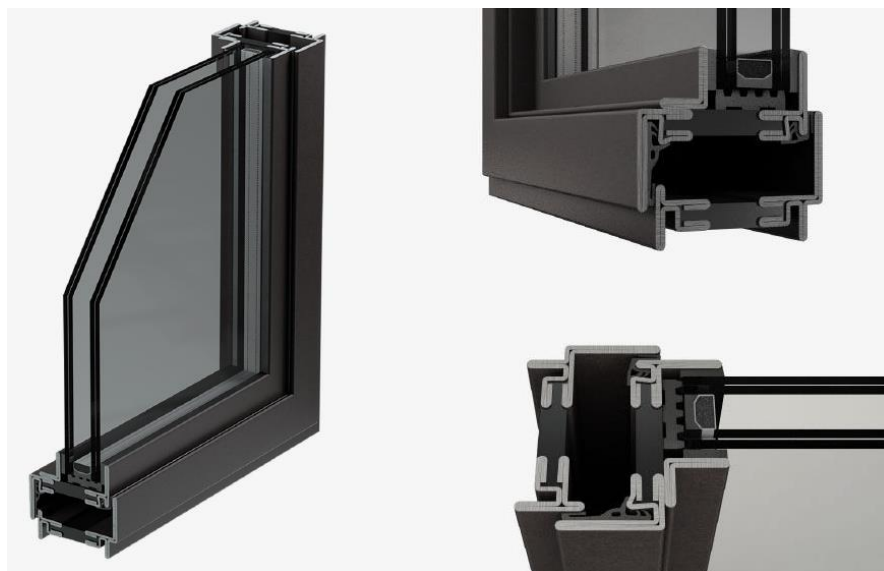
Tipologia nuovo infisso tipo ferrofinestra
